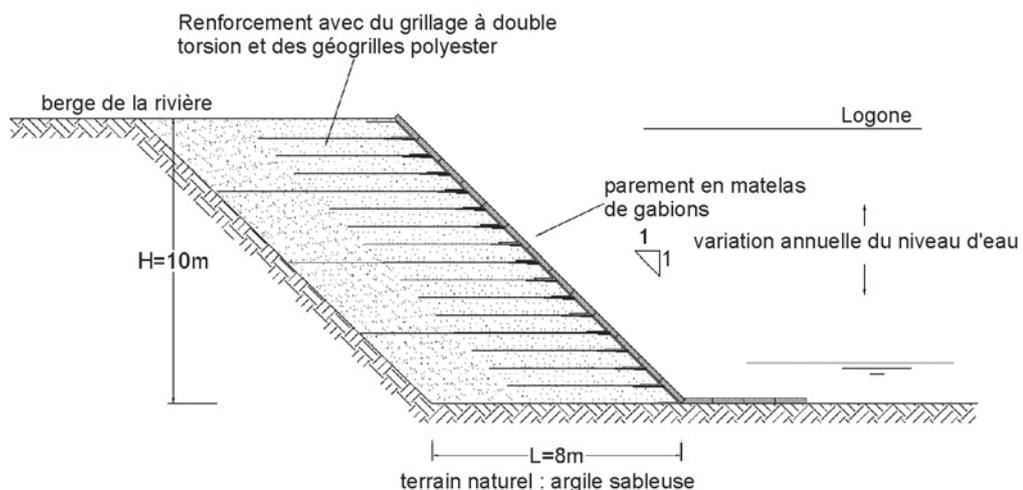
Protection de berge en gabions servant également de structure de soutènement - Logone, à Kousséri, au Cameroun
